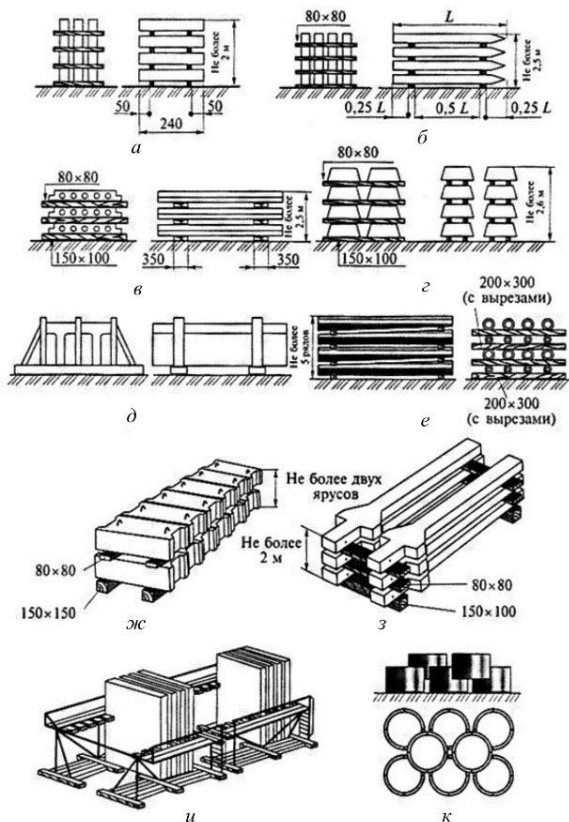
Складирование железобетонных конструкций: а – плит ленточных фундаментов; б – свай; в – плит и панелей перекрытий; г – фундаментных башмаков под колонны; д – подкрановых балок; е – центрифугированных опор ВЛ; ж – фундаментных стеновых блоков; з – колонн; и – стеновых панелей в кассетах; к – колец колодцев высотой не более 2,5 м
